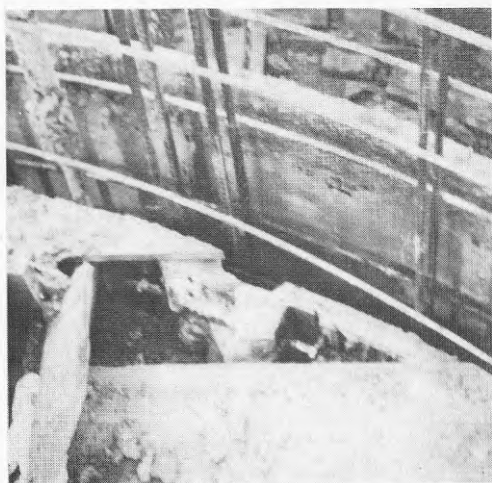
Om glidformen håller på att vrida sig görs en justering av styrskenan (se även bilaga 3.2 c). Detta kunde vara besvärligt på grund av "betongspill".
